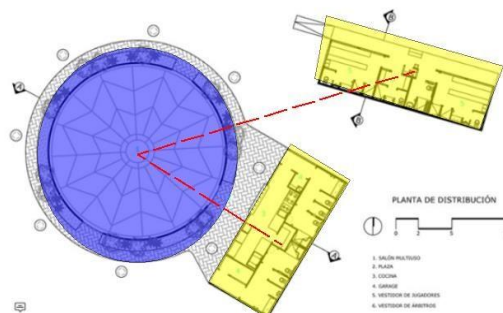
Estructuración del Conjunto, Centro El Rodeo
